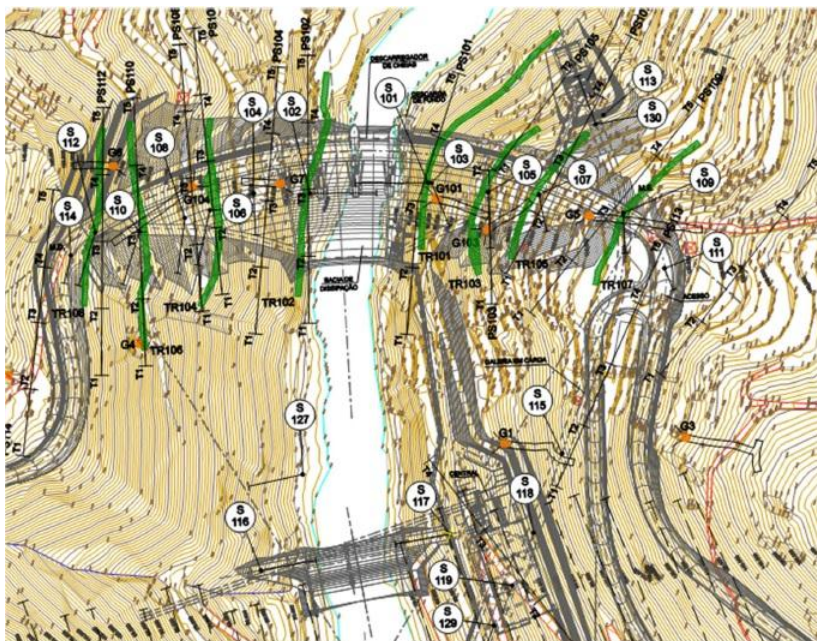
Prospeção Geotécnica no AHRE [1]
